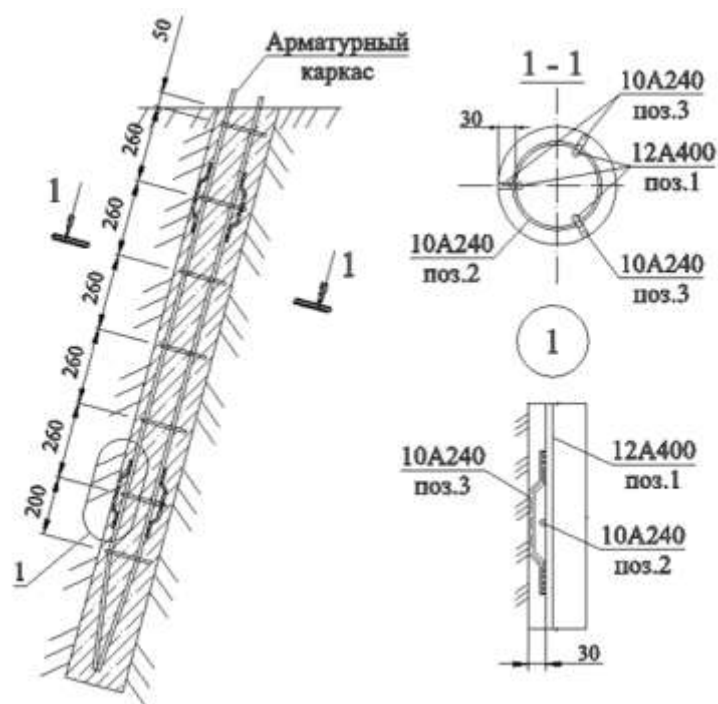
Схема монтажа арматурного каркаса с ограничителями защитного слоя
